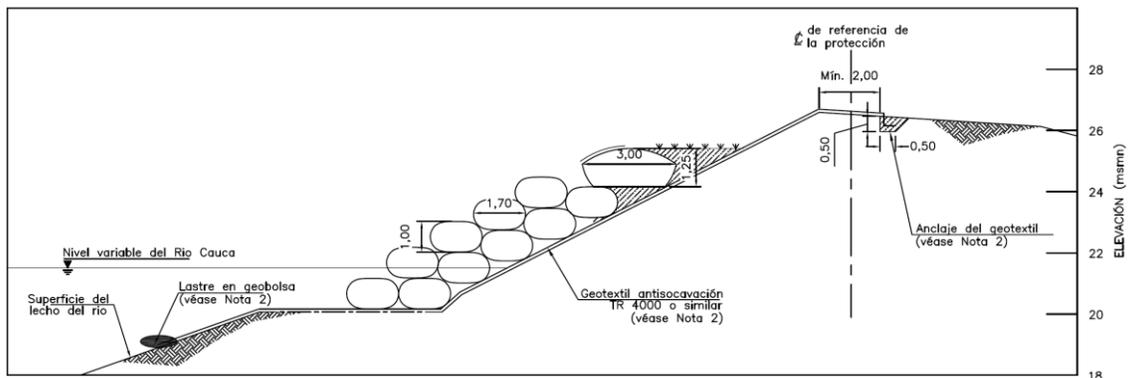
Sección de análisis de la orilla donde se construirá la protección de orilla propuesta en geobolsas y geotubos.
